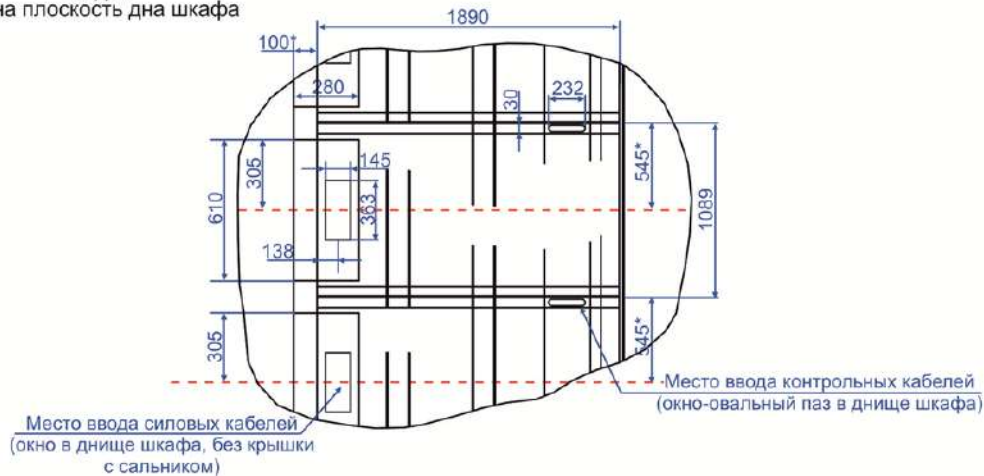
Установка КМ-1КФ в помещении РУ (монтаж и узлы крепления шкафов)
